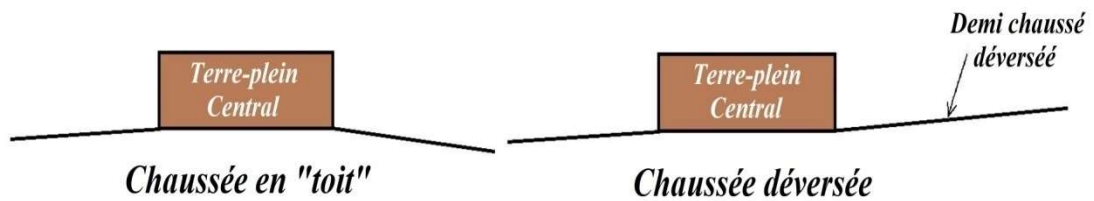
Réseau du terre-plein central pour une chaussée en "toit" et une chaussée déversée.
